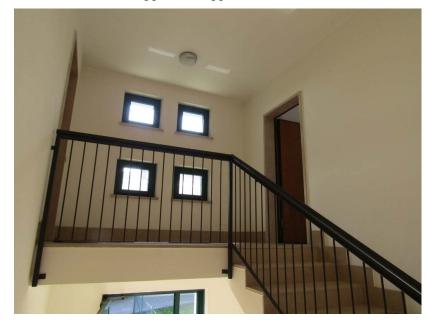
interno della scala condominiale al primo piano Enrico Zorzi architetto
